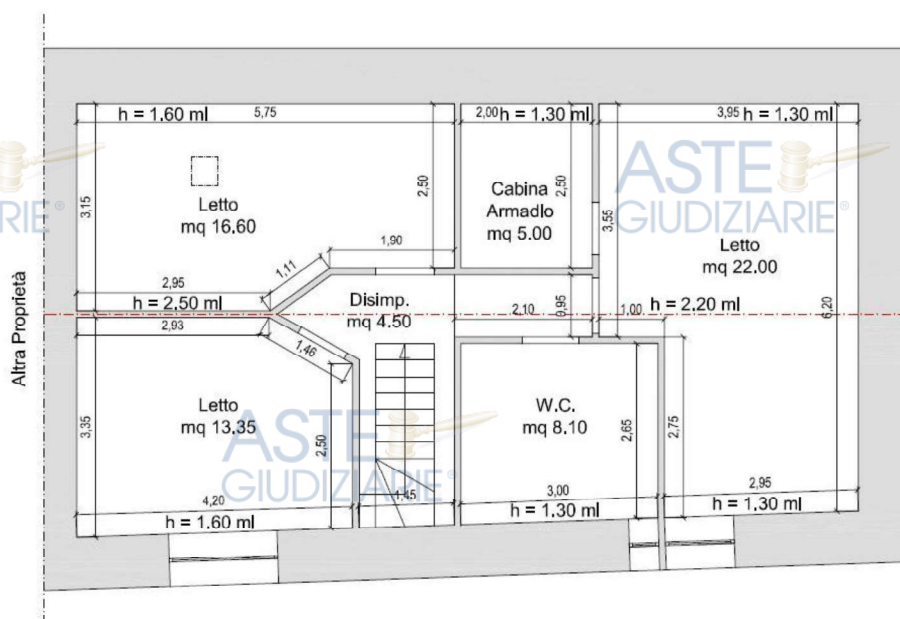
Planimetria Stato di Fatto Piano Primo, Foglio 20, p.lla 161, Sub 4.
